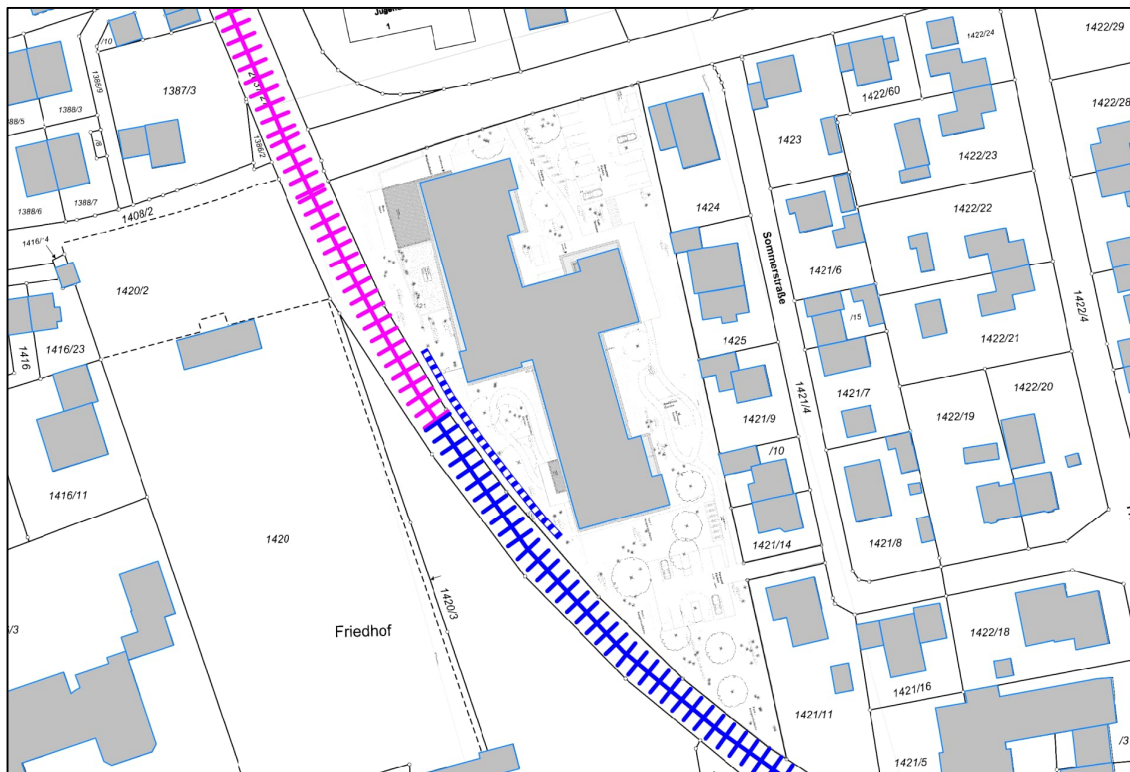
Lageplan mit Darstellung der betrachteten Bahnstrecke
